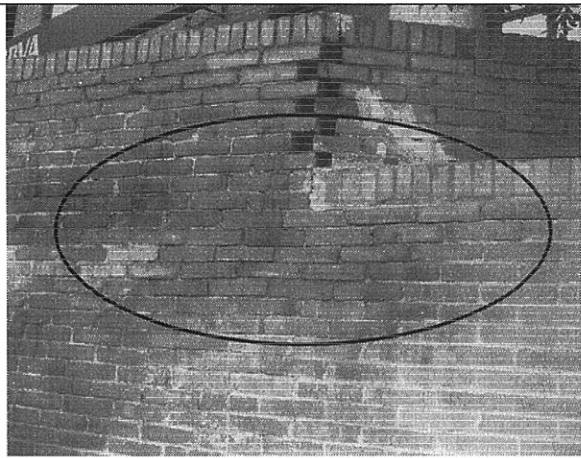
Agrietamiento diagonal en el vértice del muro sobre la calle 33
